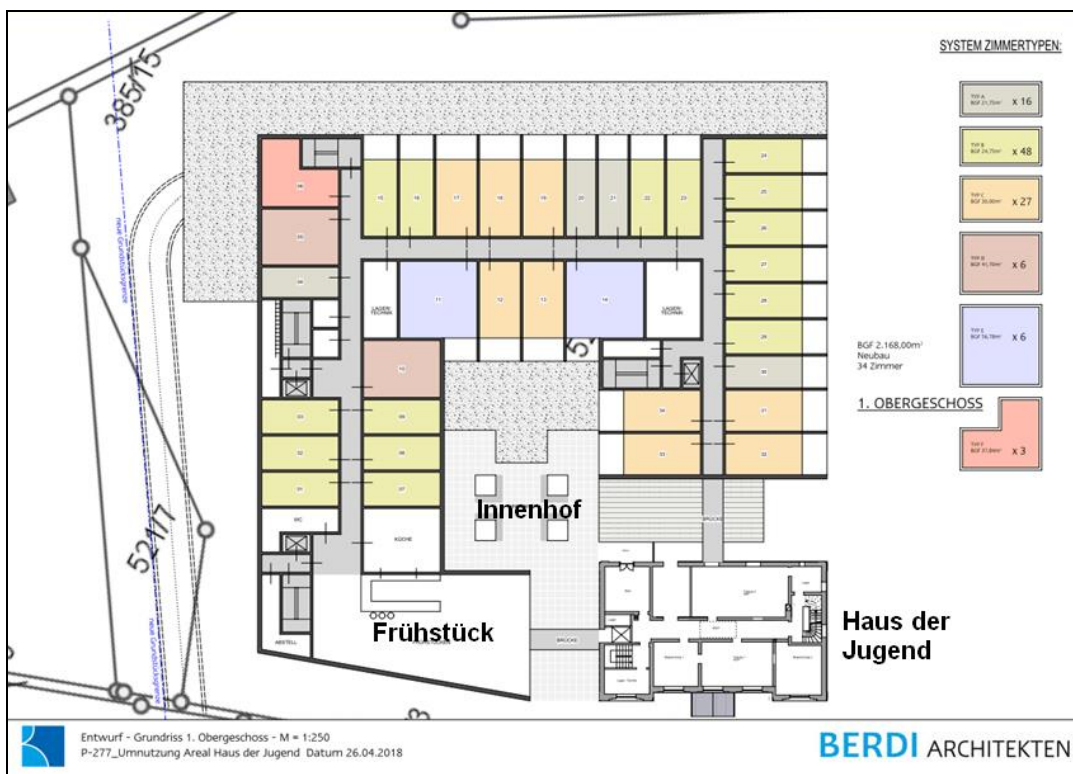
Grundriss 1. Obergeschoss (Hotelzimmer/Frühstücksraum) (Projektstand April 2018)
